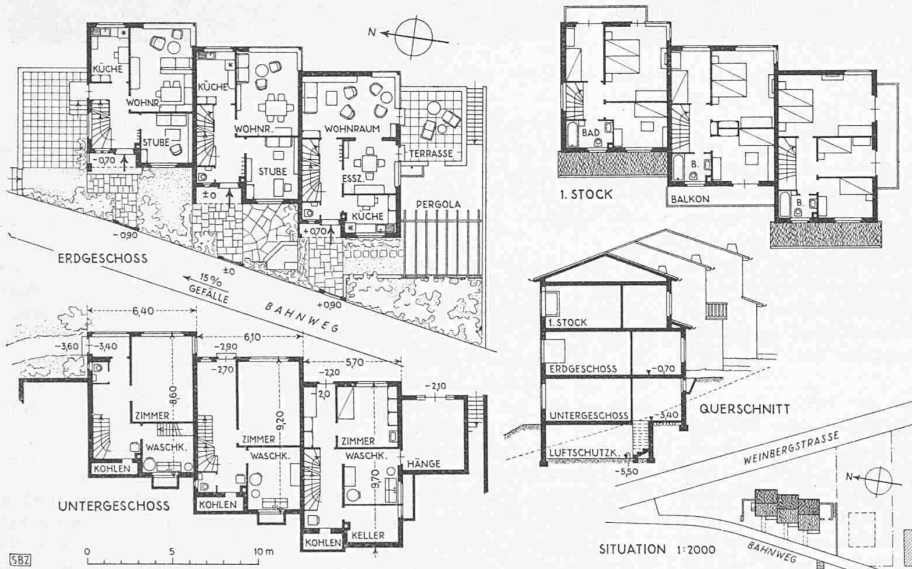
Grundrisse und Schnitte 1:400, Lageplan 1:2000
